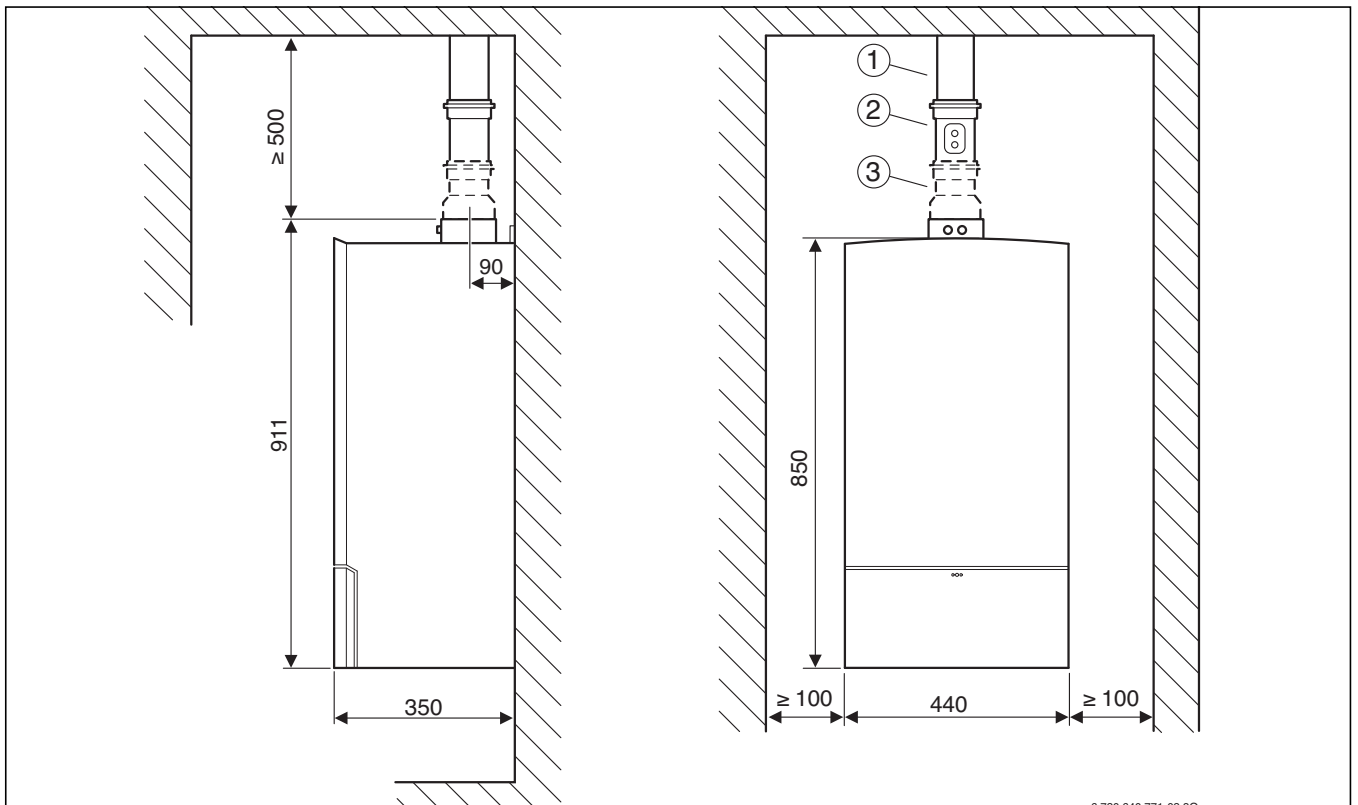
Abgasführung \varnothing 80/125 mm, \varnothing 80 mm oder \varnothing 60/100 mm
